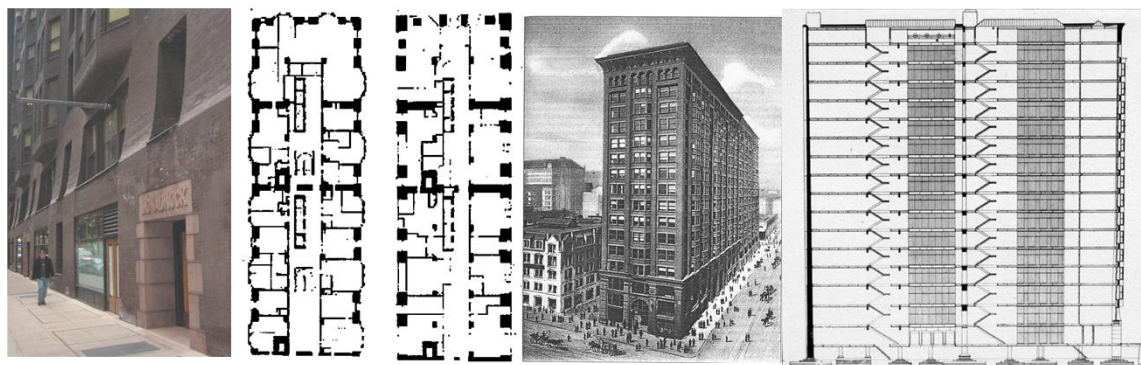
Monadnock Building, Chigago (1891/93), alvenaria estrutural tijolo (norte), aço (sul)
